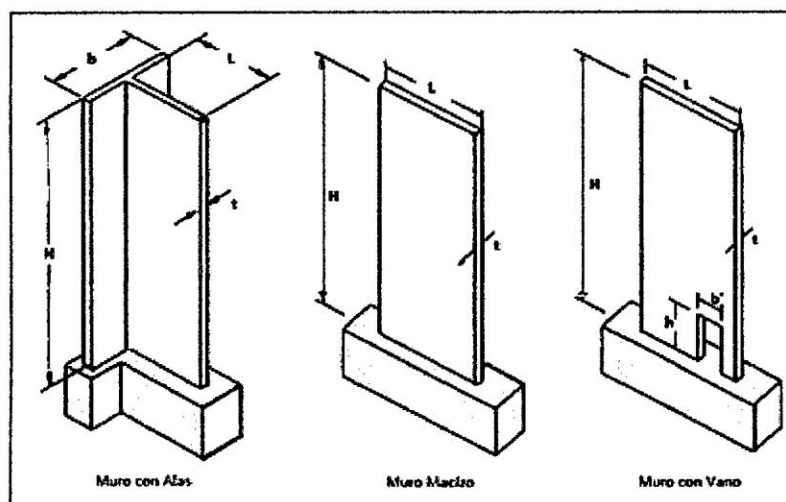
Distintos tipos de muros de concreto armado Fuente:
